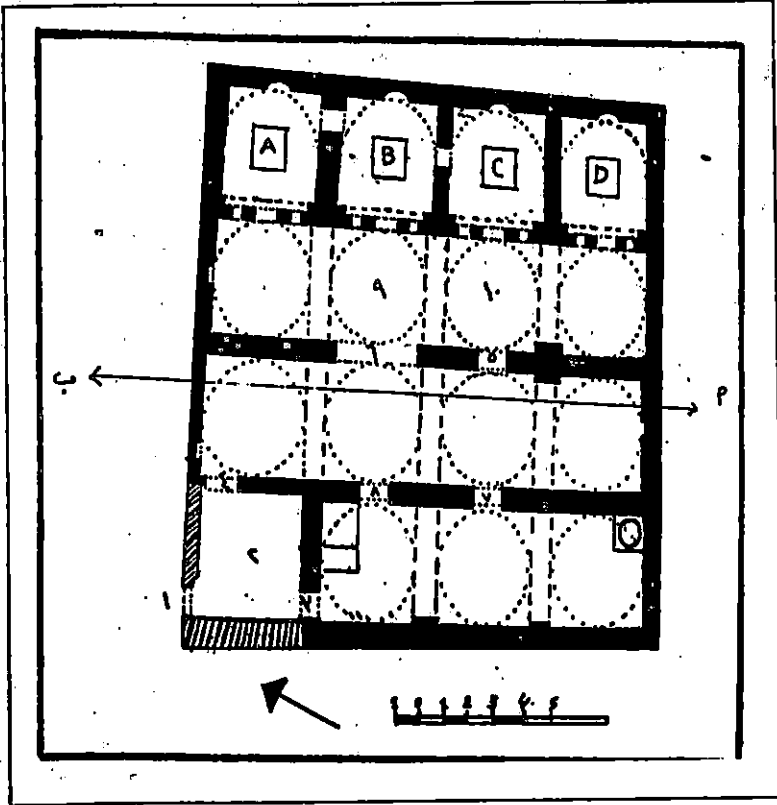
مسقط أفقى لكنيسة دير المجمع بنقادة، عمل الباحث
